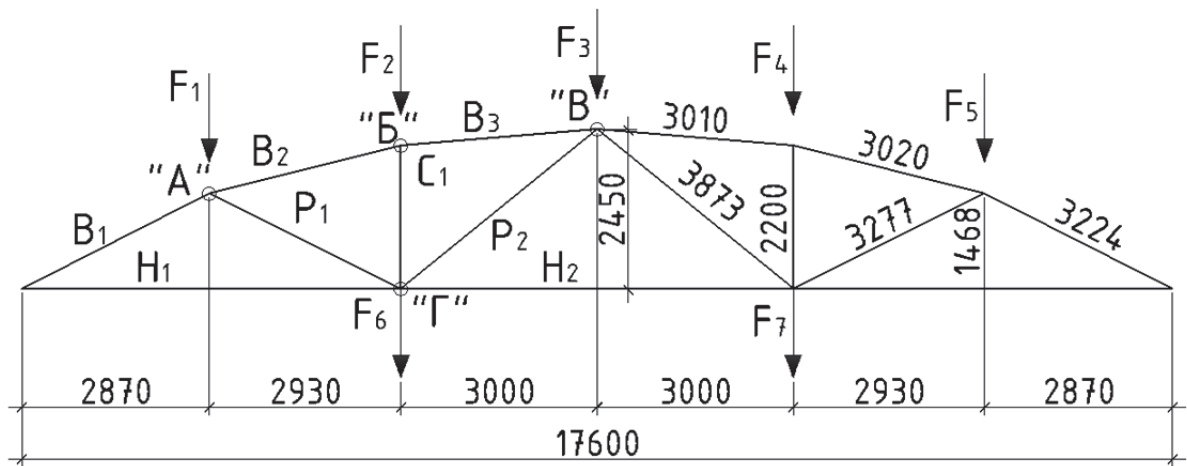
Геометрическая схема фермы пролетом 18 м
